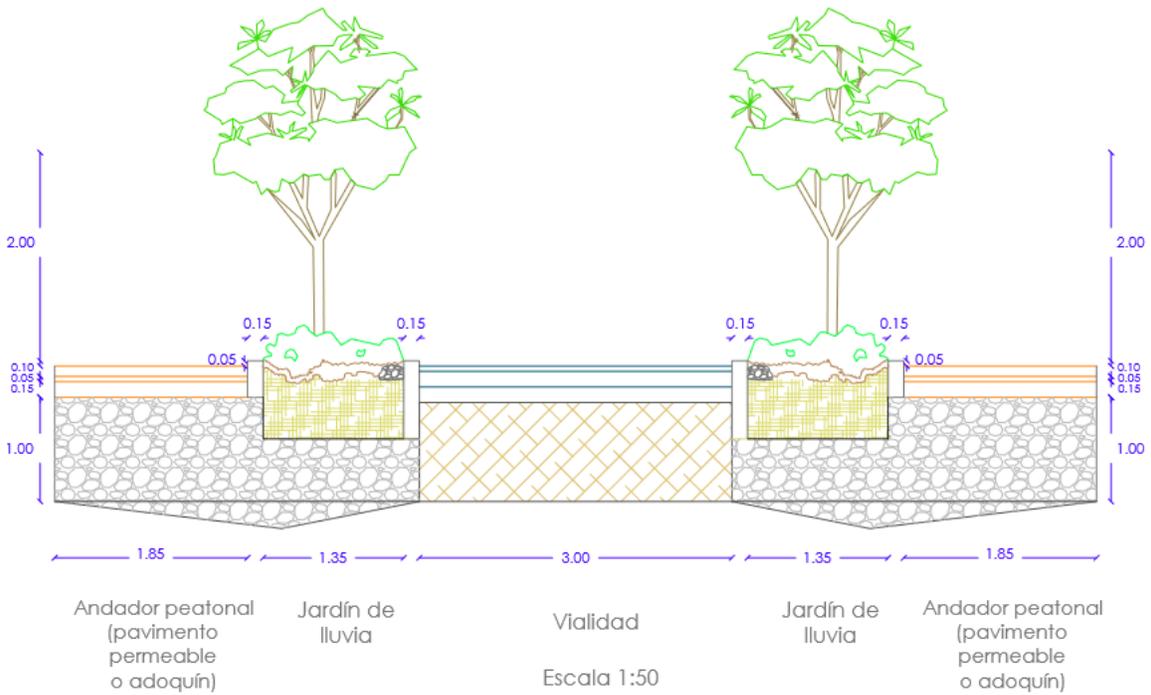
Detalle constructivo de jardín de lluvia. Corte muestra para corredor verde con jardín de lluvia y pavimento permeable Fuente: Elaboración propia.
